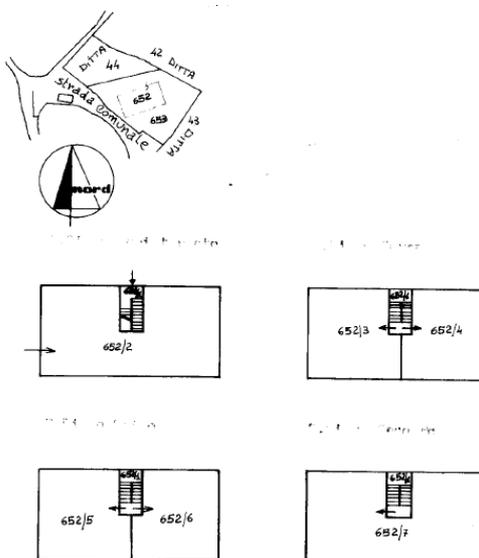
Stralcio planimetrico Foglio 21, part. 652, sub 10 (ex sub. 2) – sub. 3 e sub.4- Comune di Sant'arcangelo
